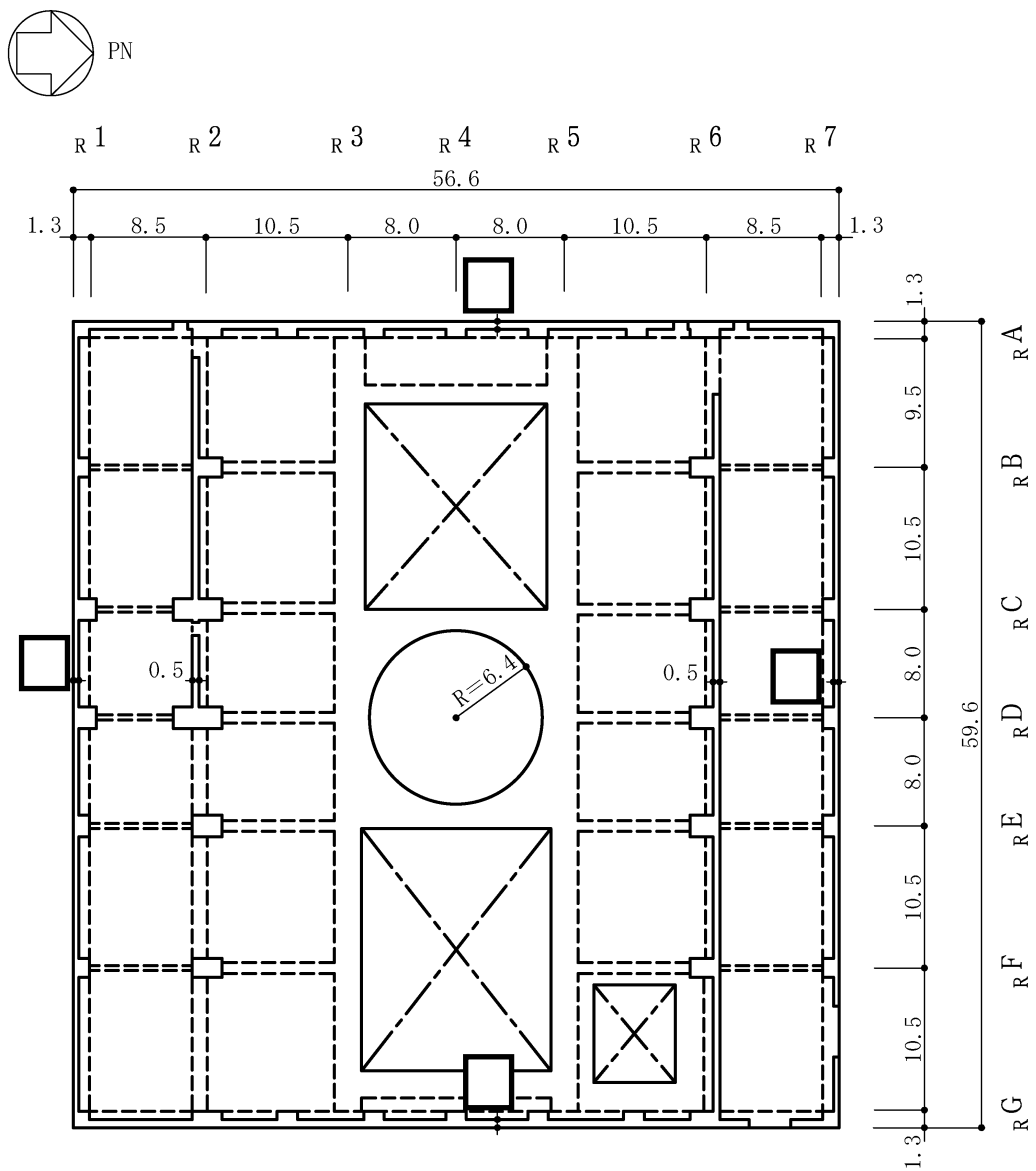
原子炉建屋の概略平面図 (4F, T.M.S.L. 31.7m) (単位:m) (7/9)
